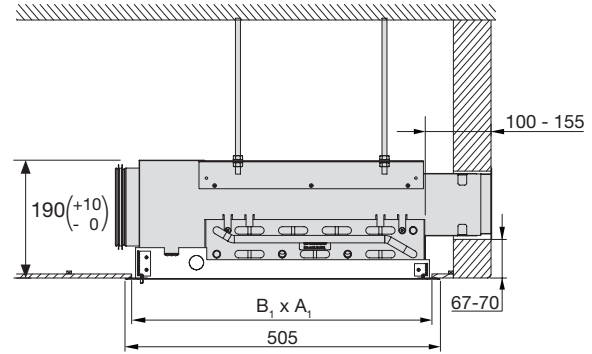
Montagezeichnung für Frontplatte -3 und -3E mit Ausschnittmaßen.
